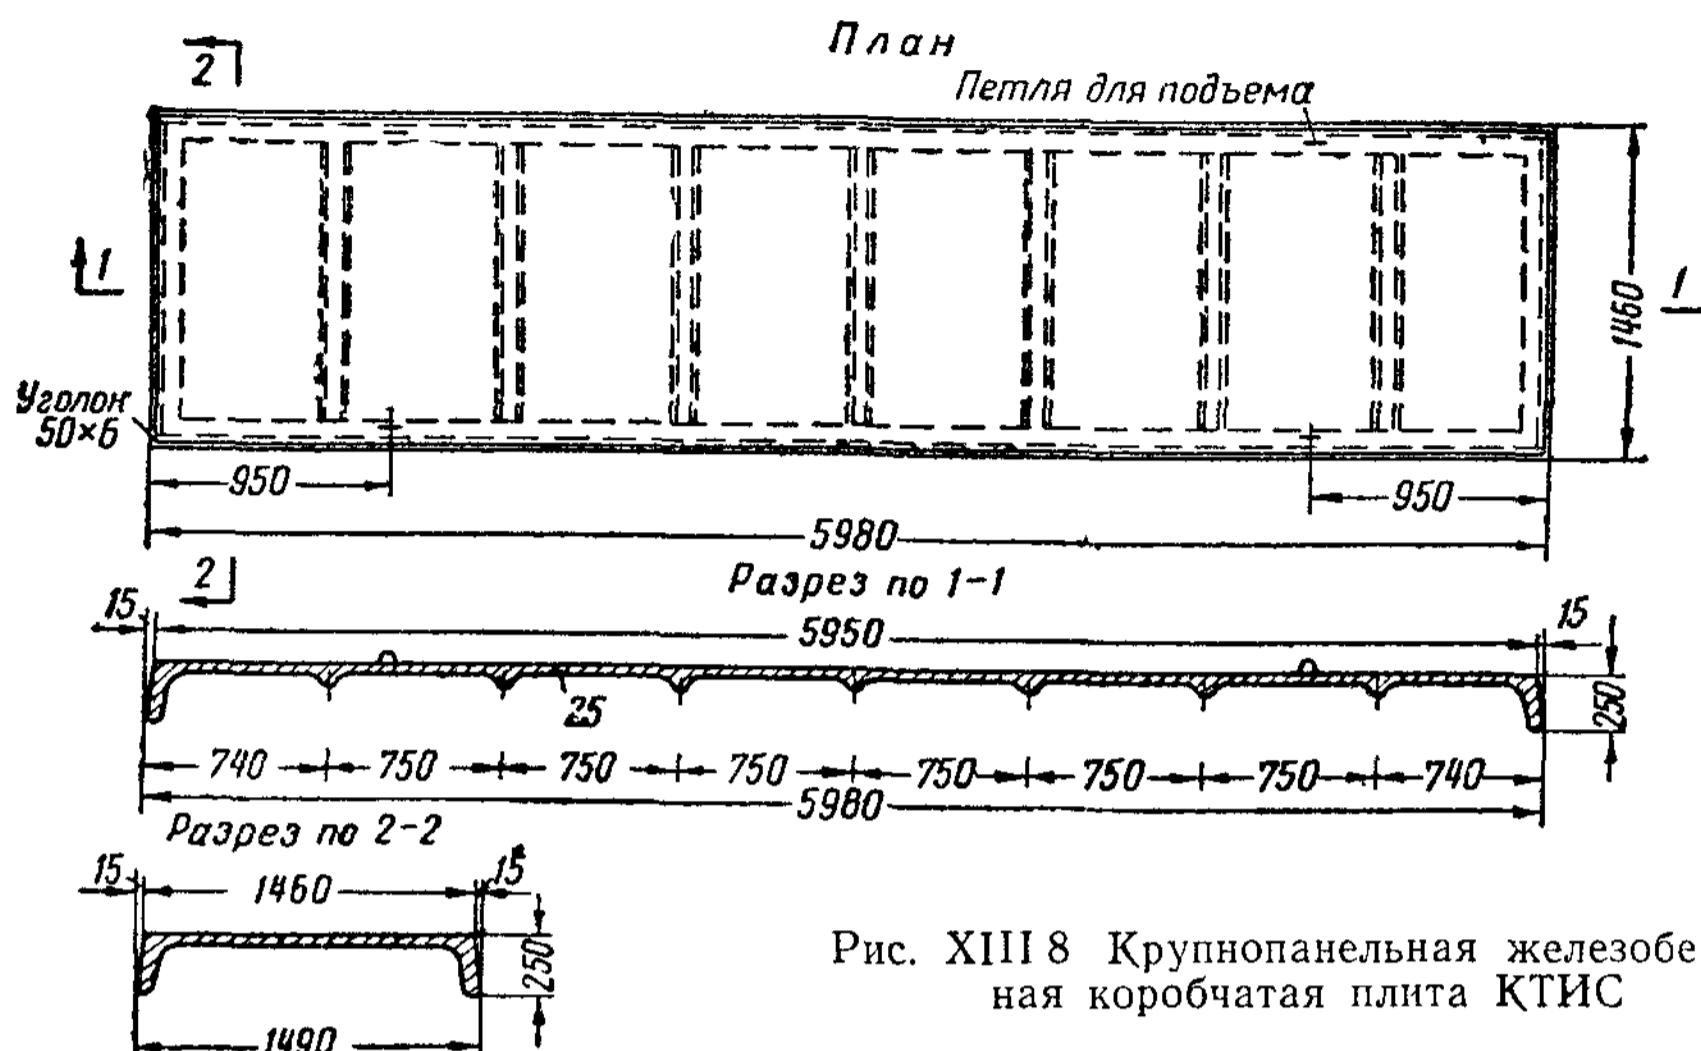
Крупнопанельная железобетонная коробчатая плита КТИС
